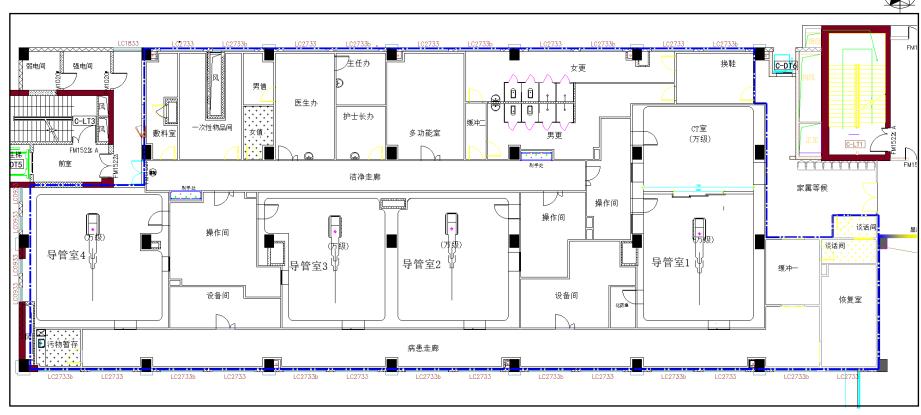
北京友谊医院通州院区国际医疗三层介入中心平面图
